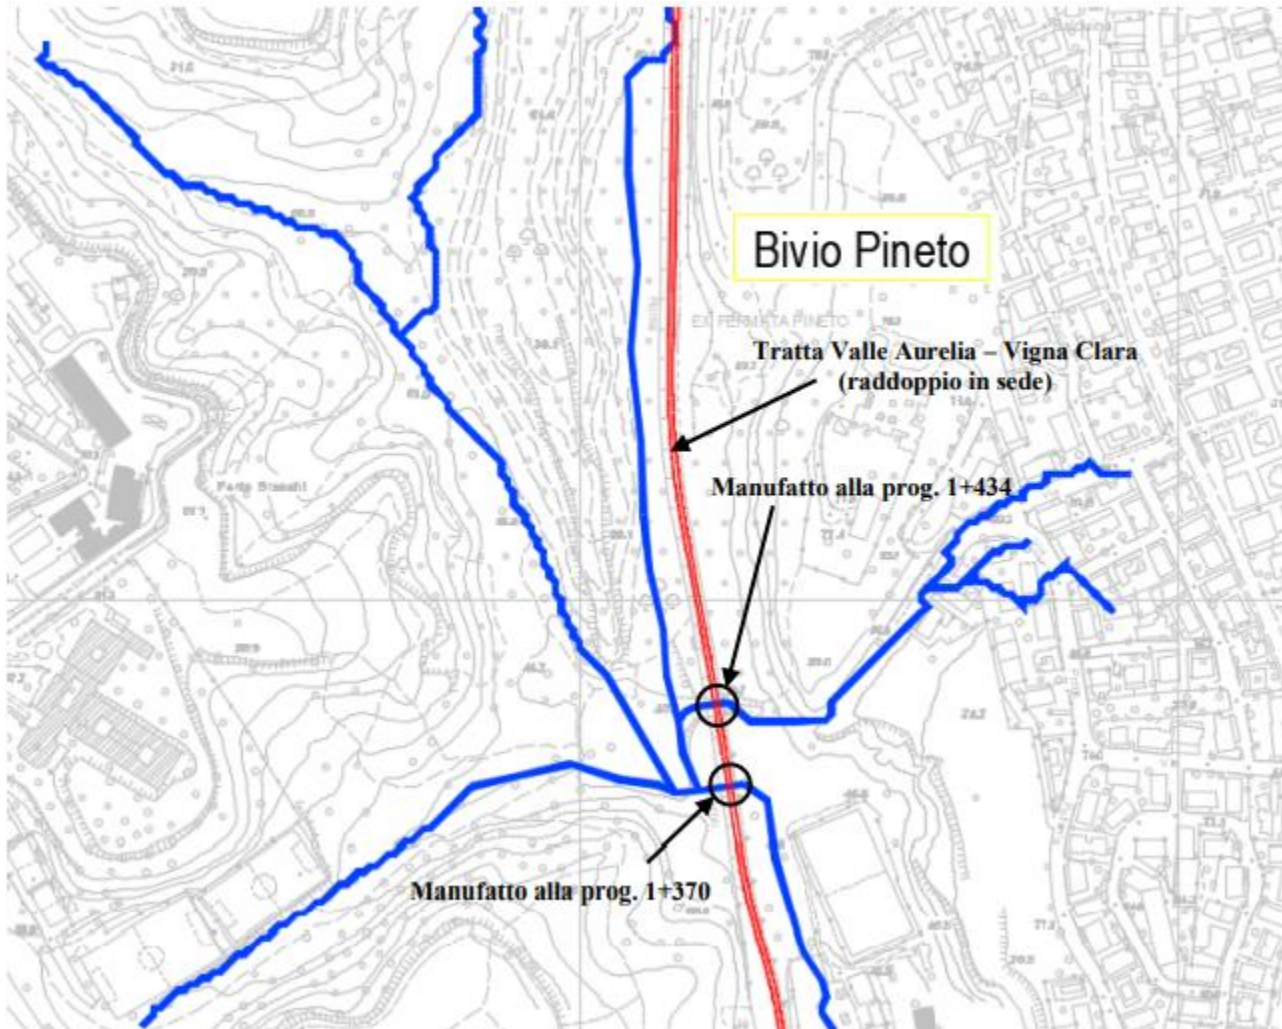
Manufatti idraulici esistenti alle progr. 1+370 e 1+434: stralcio planimetrico.
